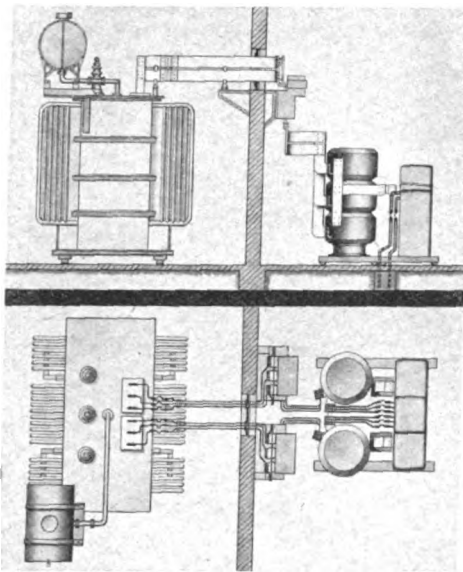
Maßstabgerechte Bauskizze einer ausgeführten Anlage für 8000 A und 70 bis 400 V regelbar. Umspanner wie in Bild 16 mit je einer Stern- und Dreieckswicklung. Parallelschaltung ergibt 12phasige Welligkeit. Das Bild soll das Größenverhältnis der Schaltdrosseln und des Kontaktapparates zum Umspanner gleicher Leistung zeigen. Das Kontaktgerät ist für einen Nennstrom von 10 000 A, also in dieser Anlage nicht voll ausgenutzt.
